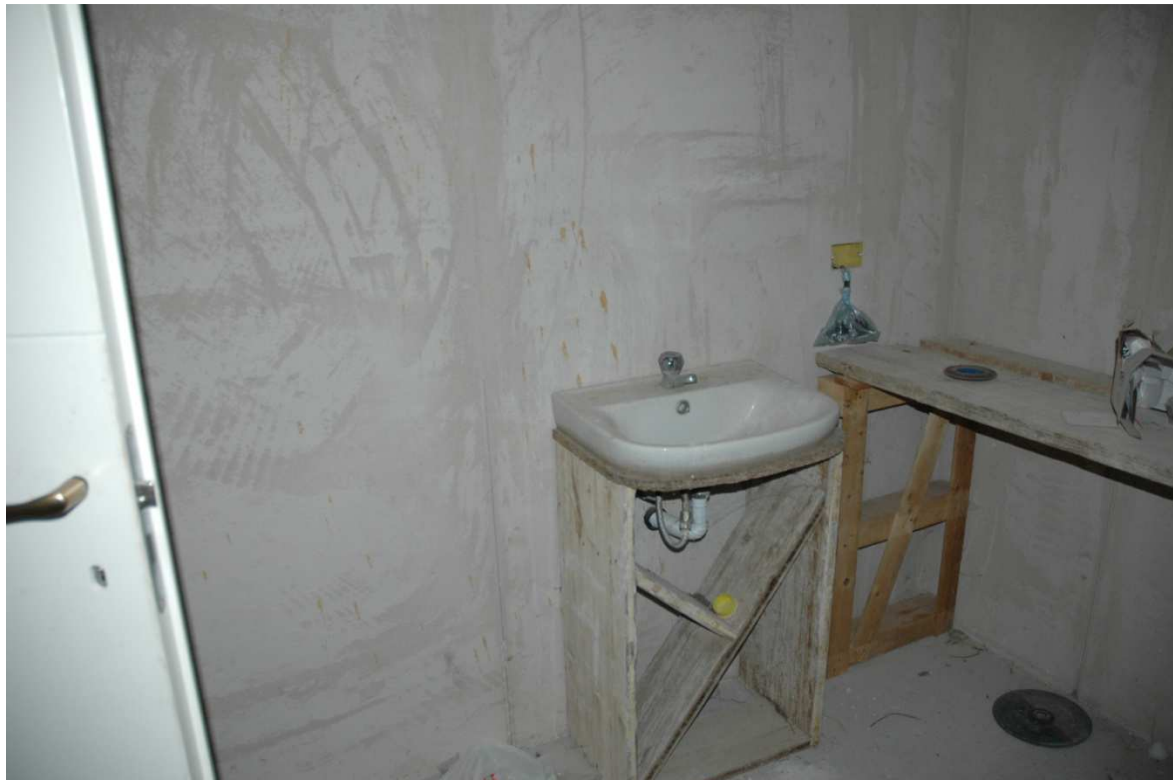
Nelle porzioni più basse sono stati ricavati dei ripostigli.
